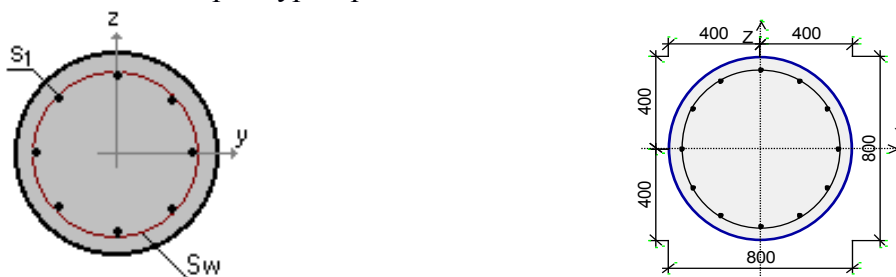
Результати підбору армування для двовимірної схеми: повздовжня арматура S1 – 12Ø25; поперечна арматура SW – Ø14; крок поперечної арматури 100 мм
